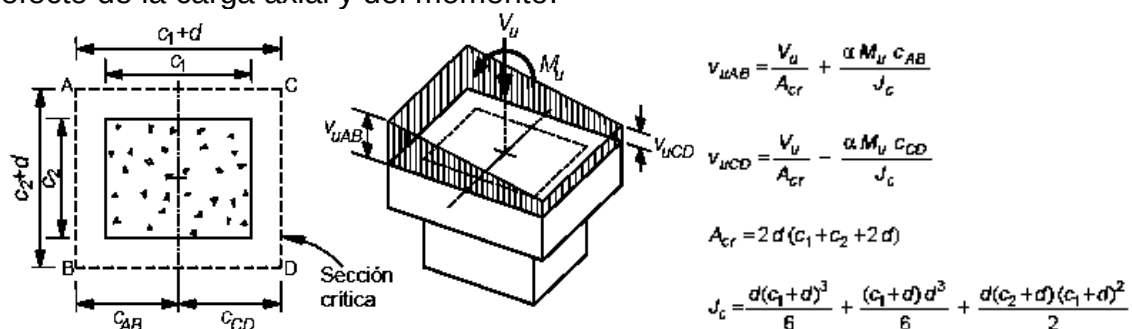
(g) Transmisión de momento entre columna rectangular y losa o zapata
